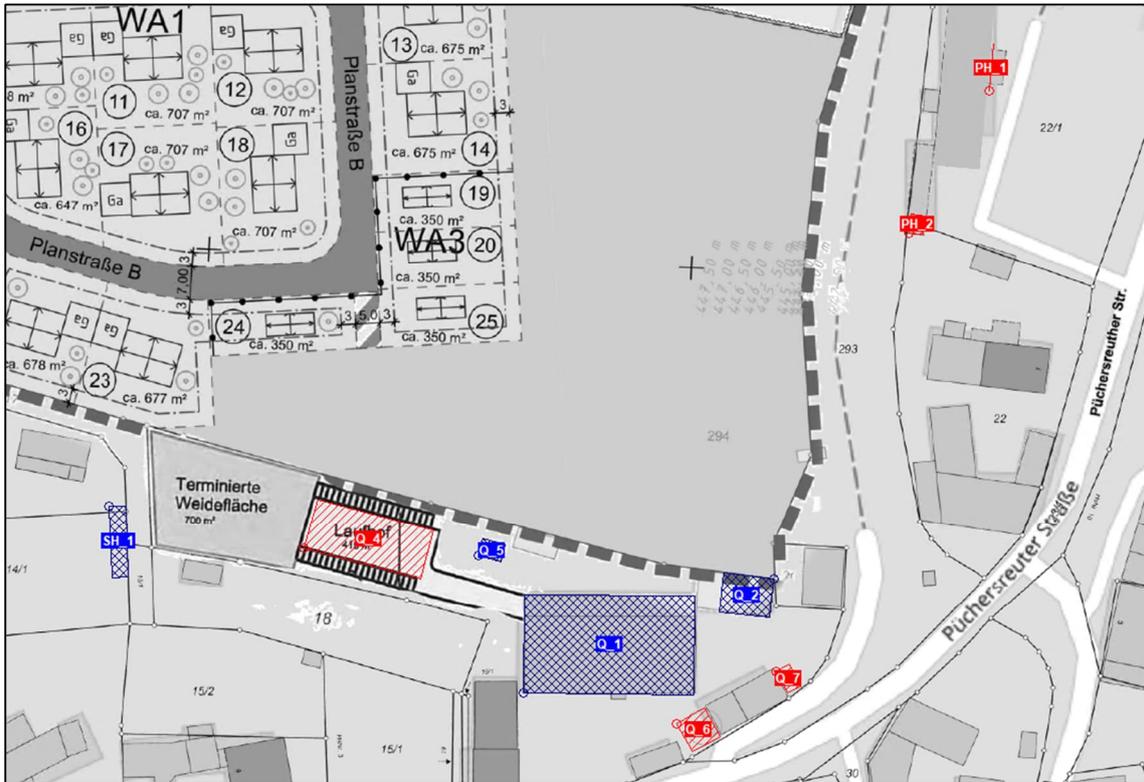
Lageplan mit Darstellung der modellierten Quellen Störstein innerorts
